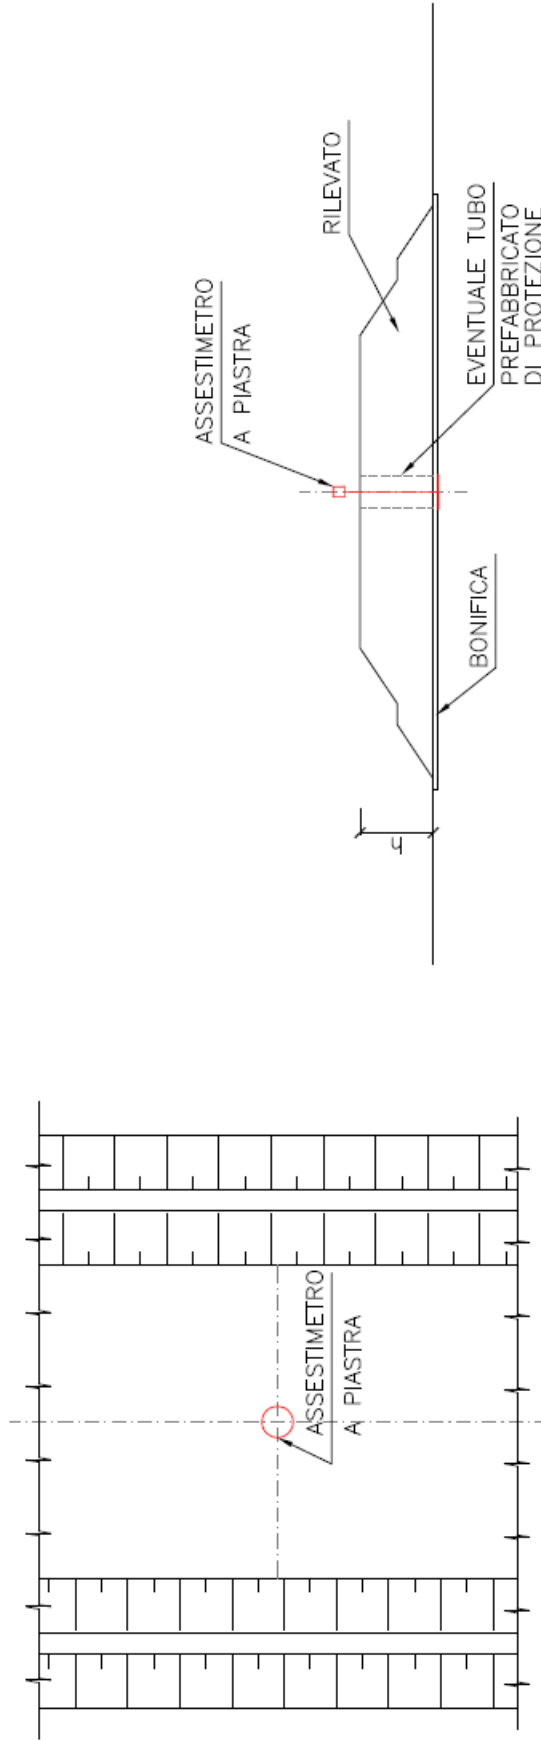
Schema sezione di monitoraggio per rilevati alti.
